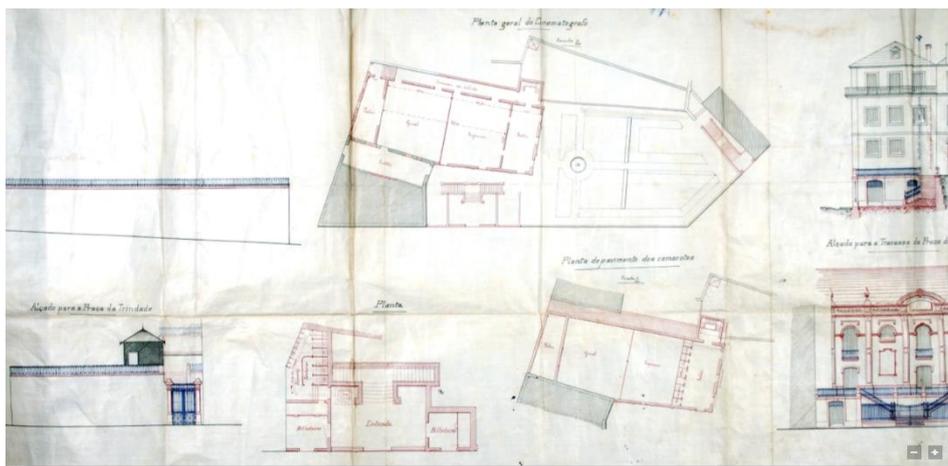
Plantas Geral do Cinematógrafo, do pavimento térreo e das escadas principais
